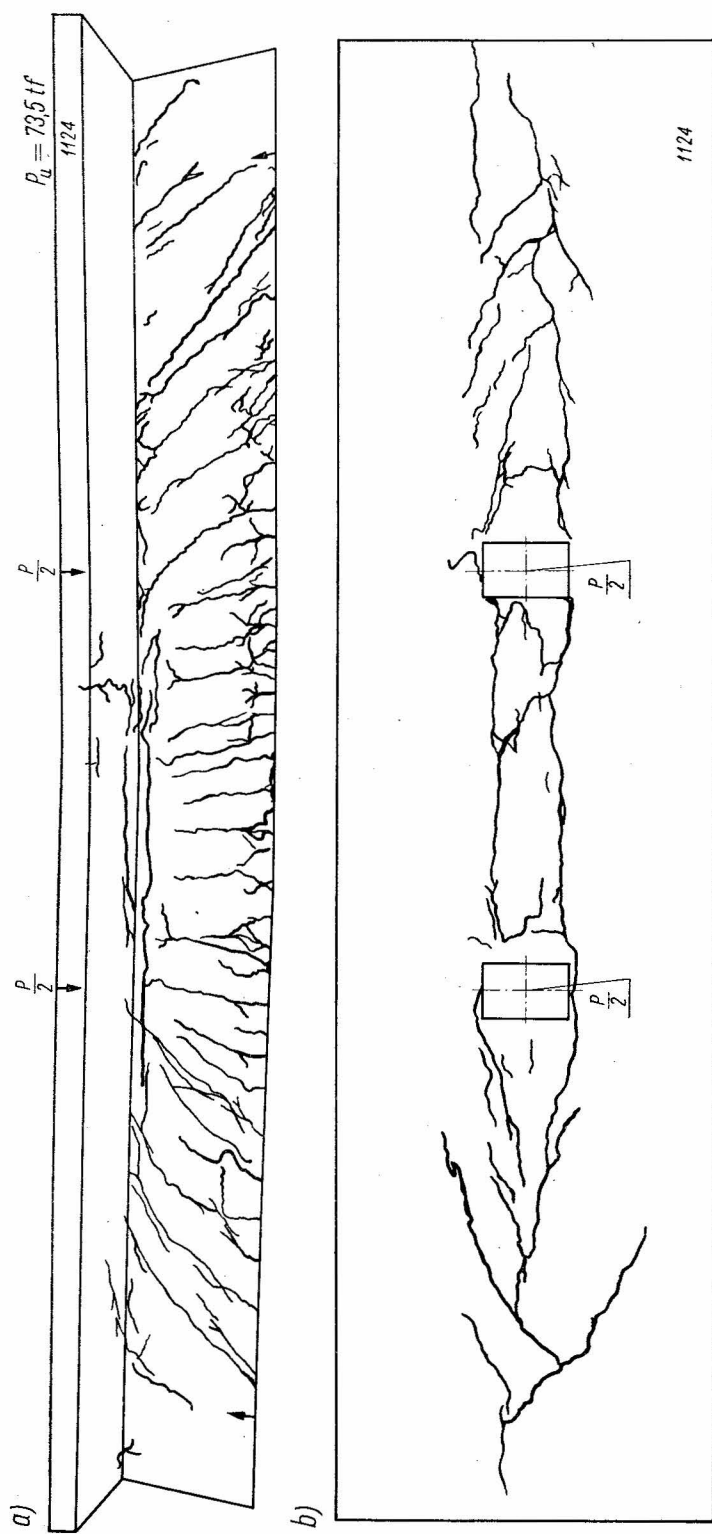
Fissuration de la poutre No 1124 [29] : a) vue latérale, b) vue de la face supérieure
